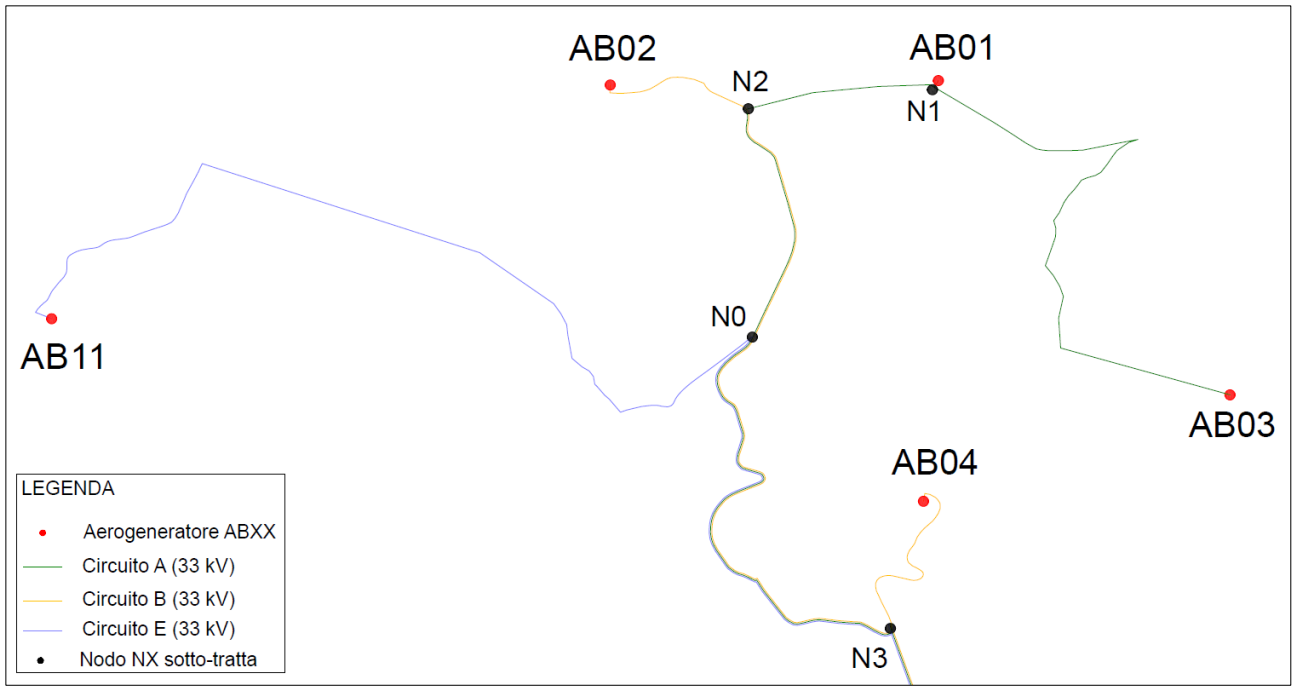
Planimetria generale di distribuzione linee a 33 kV e a 36 kV
